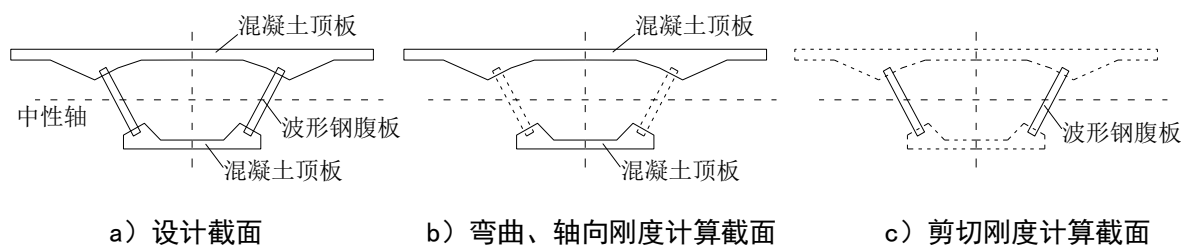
波形钢腹板预应力混凝土组合梁有效截面示意图
